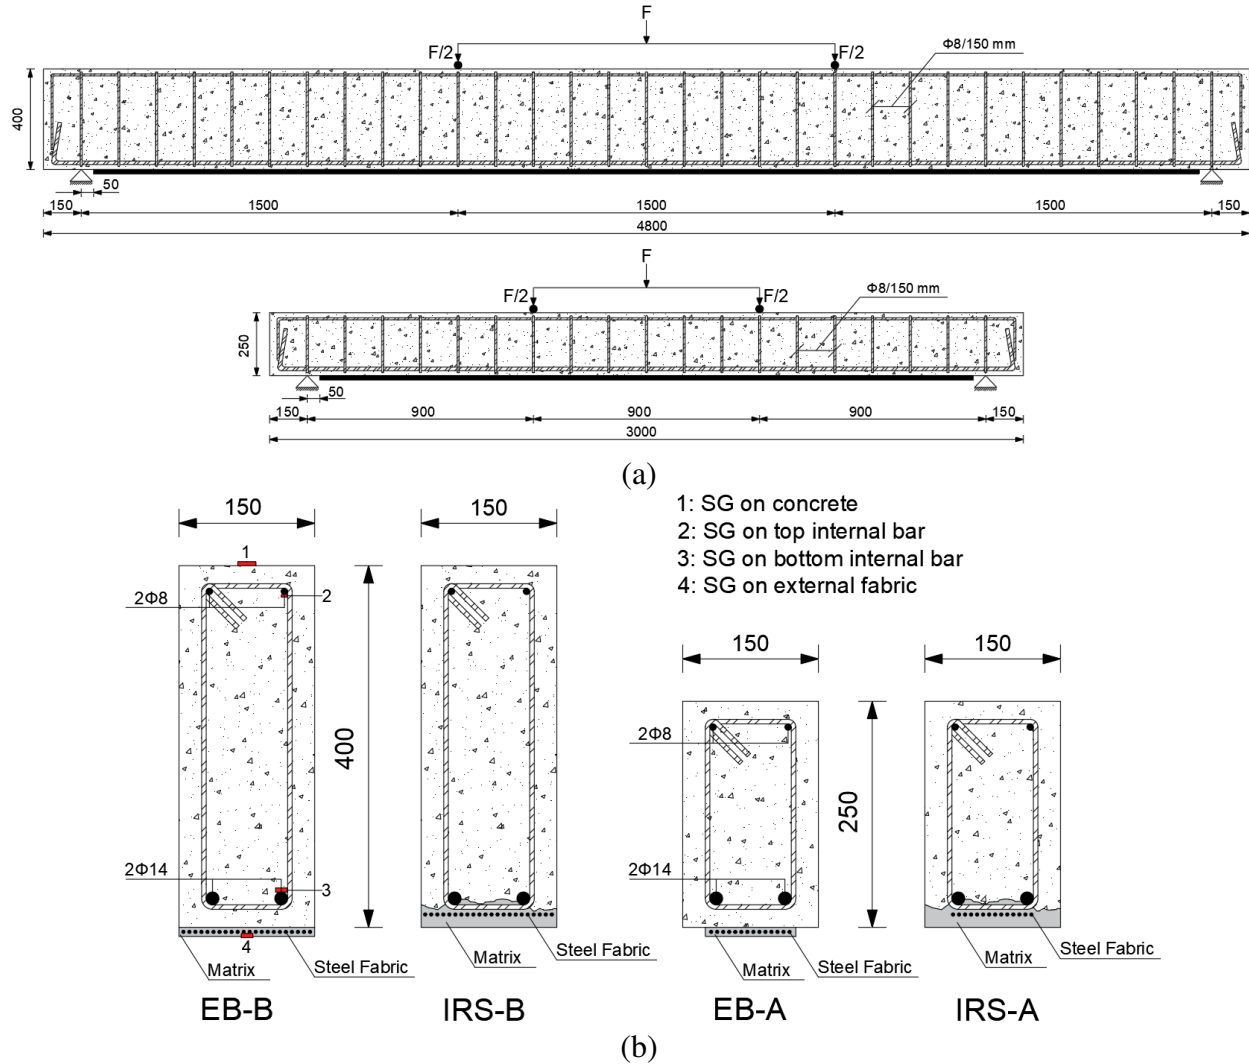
(a) dimensioni geometriche delle travi e disposizione dei rinforzi di acciaio interni ed esterni; (b) sezione trasversale delle travi, tecniche di rinforzo e posizione degli estensimetri.
